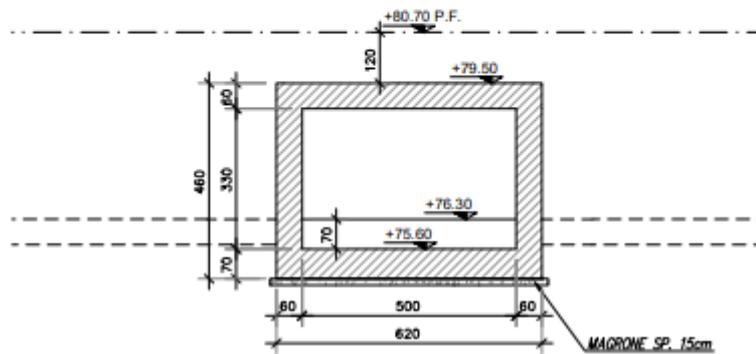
SL24 – Sezione trasversale struttura scatolare
